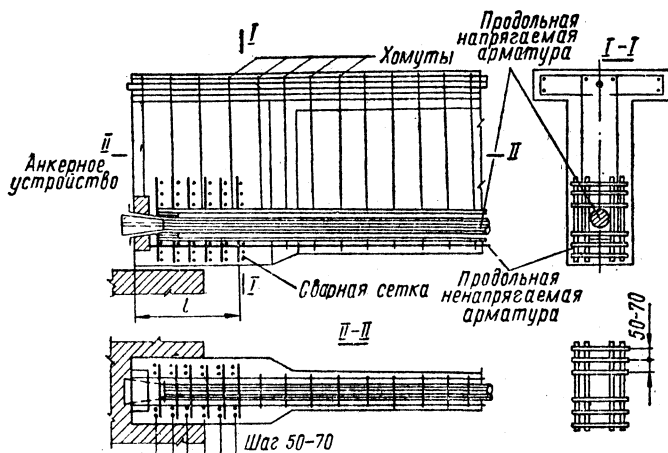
Усиление конца изгибаемого предварительно напряженного элемента со стержневой арматурой уширением элемента у опоры и установкой поперечных сварных сеток.
